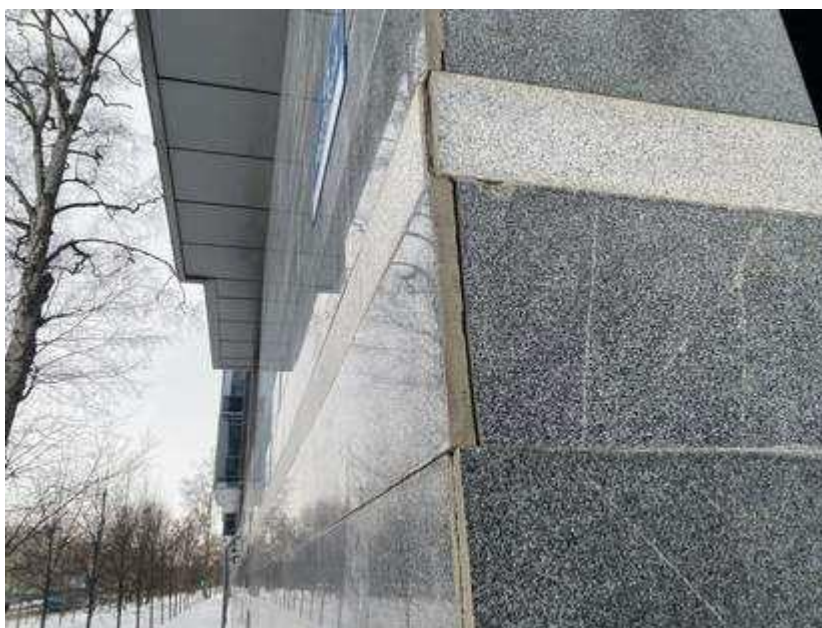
Неплотное прилегание плиток на площади до 50 % облицовки., Раствор основания разрушен.
